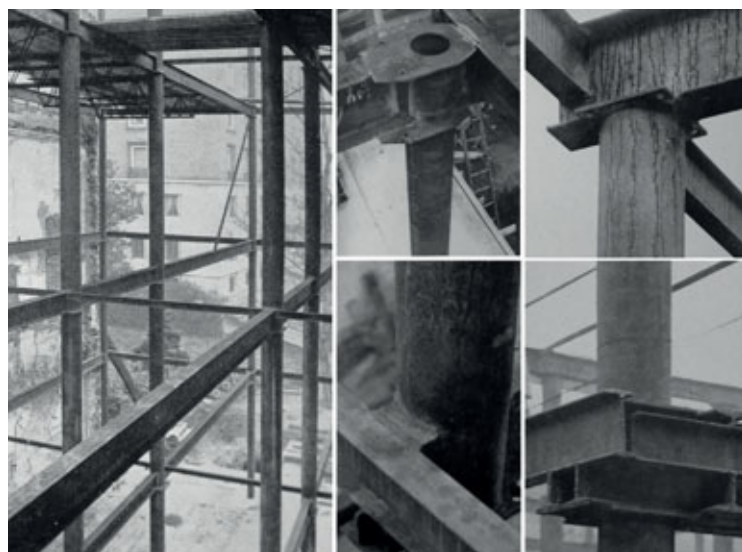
Progetto e costruzione della sede della Sidercomit (1958-1960): realizzazione della struttura in acciaio e dettagli dei nodi trave-colonna (Fondazione Dalmine).
